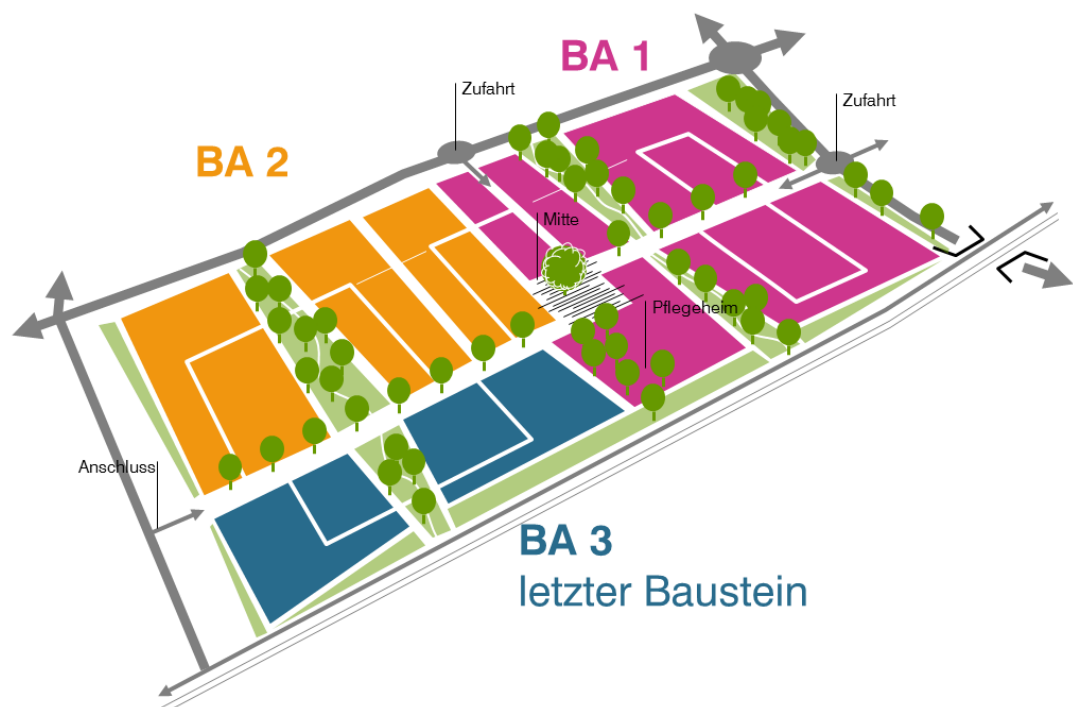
Bauabschnitte zum städtebaulichen Konzept
